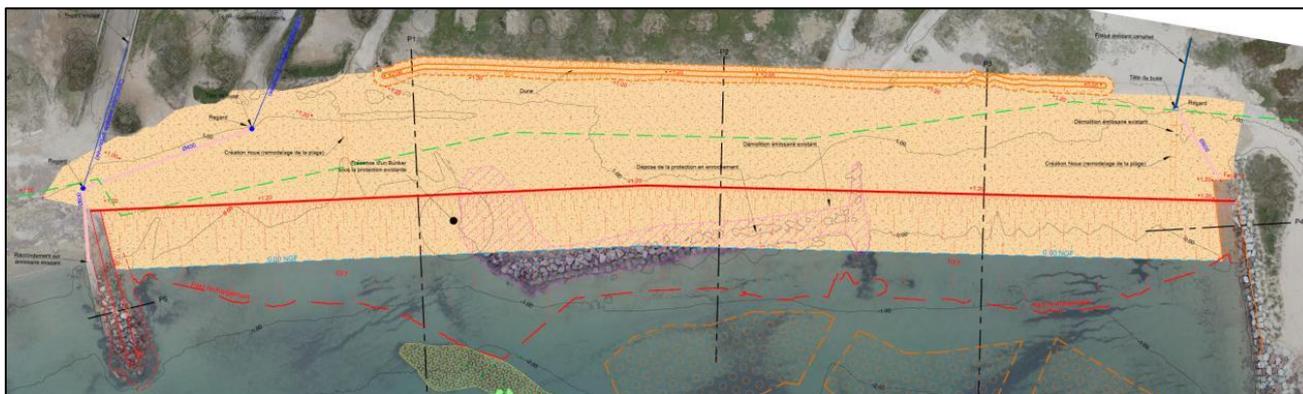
Extrait du plan de phase PRO présentant l'emprise du rechargement de plage
